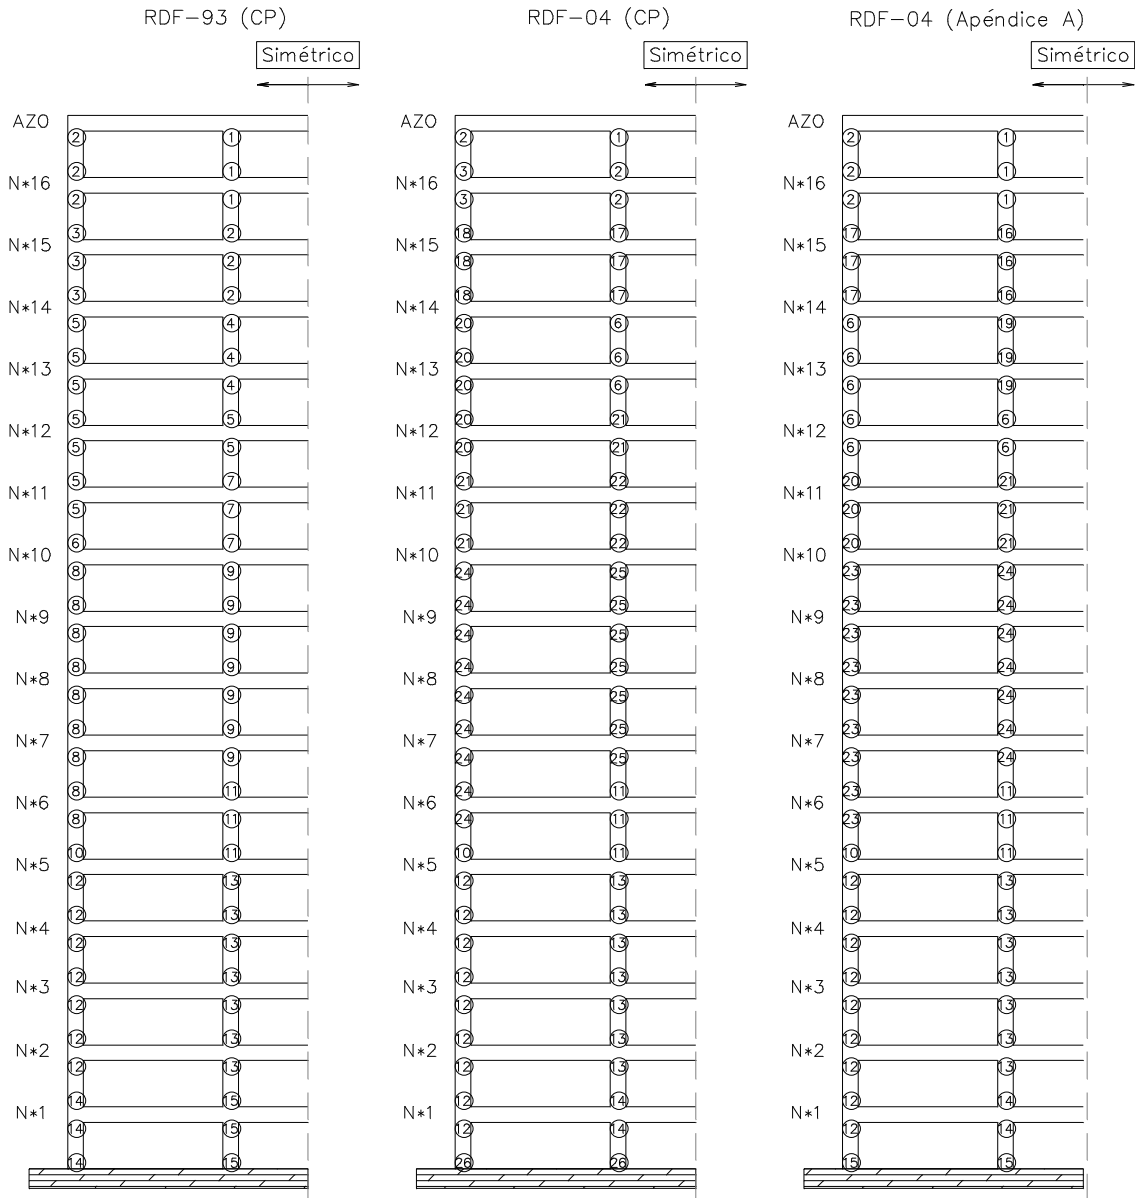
Ubicación de los tipos de armados de columnas del eje 2, estructuras de 17 niveles diseñadas en zona III (RDF-93 y RDF-04)
